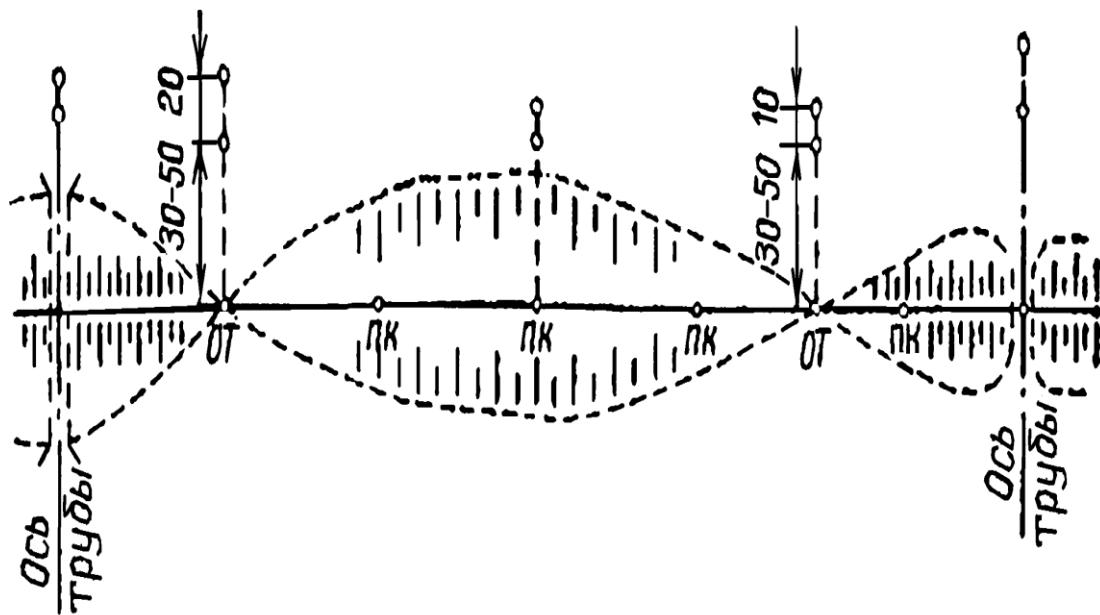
Схема закрепления основных точек трассы за зоной строительных работ
